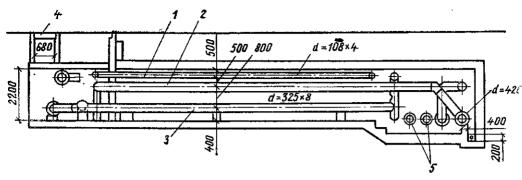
Схема укладки в туннеле водопроводных и технологических трубопроводов
